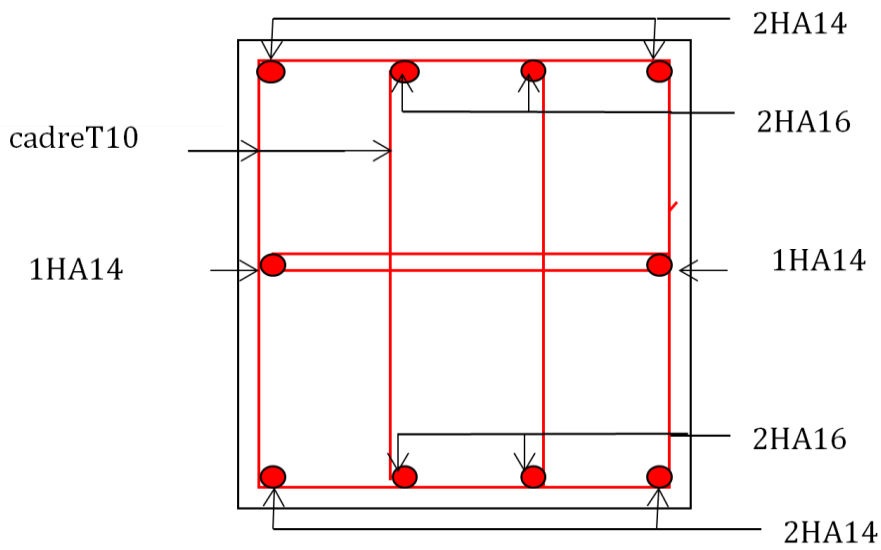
Ferrailage poteaux 8^{ème} à 10^{ème} étages.
